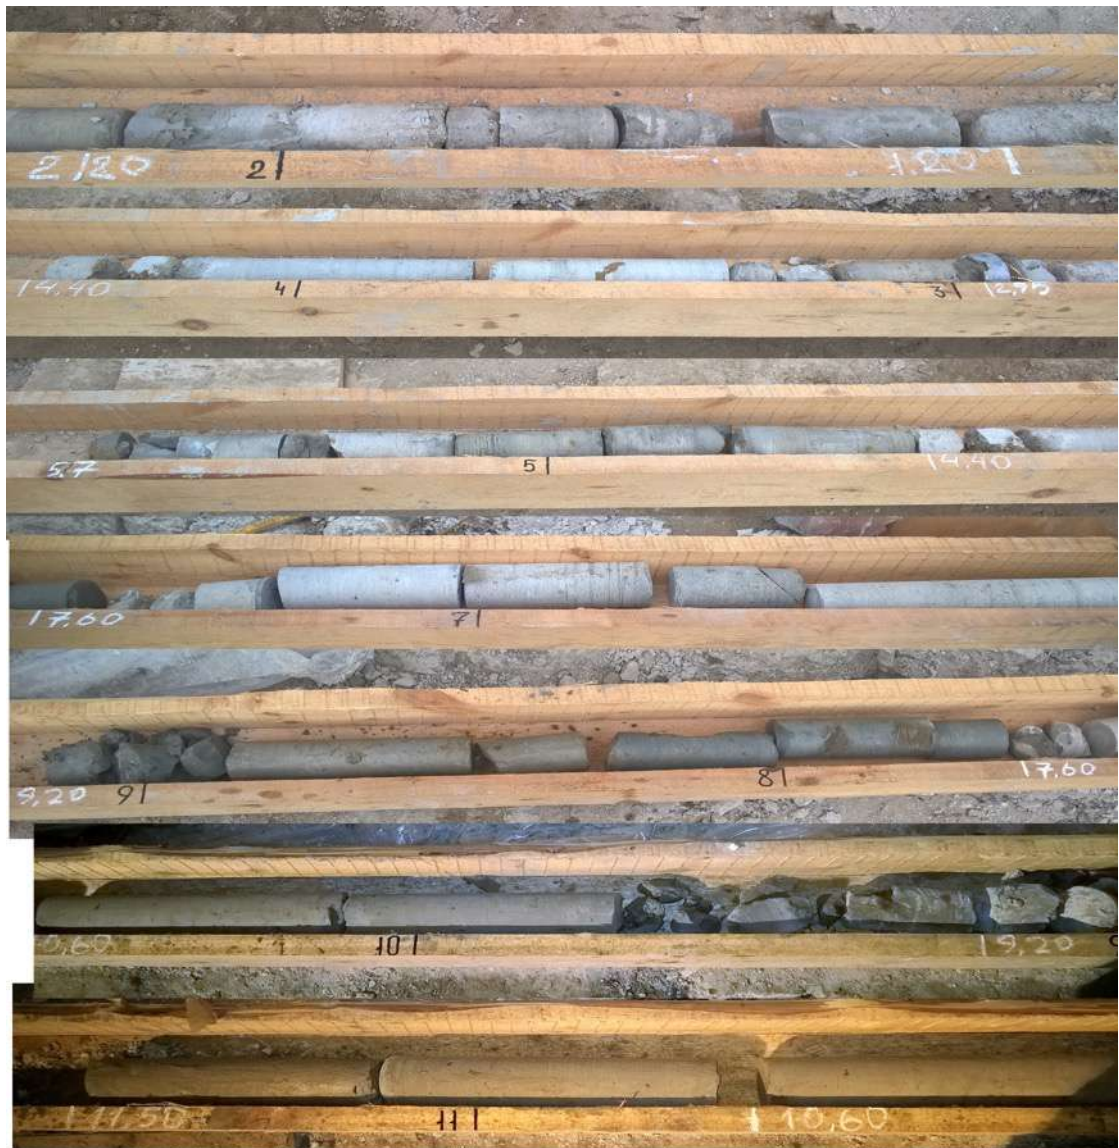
Контрольные образцы грунтобетона верхних 11,5 м грунтобетонного элемента
